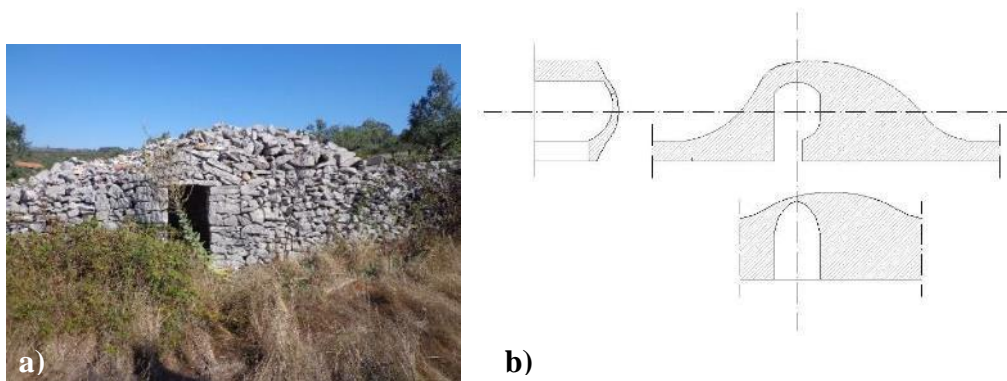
Abrigo de pastor: a) Integrado em muro, sem destaque em alçado; b) Tipologia - Planta
